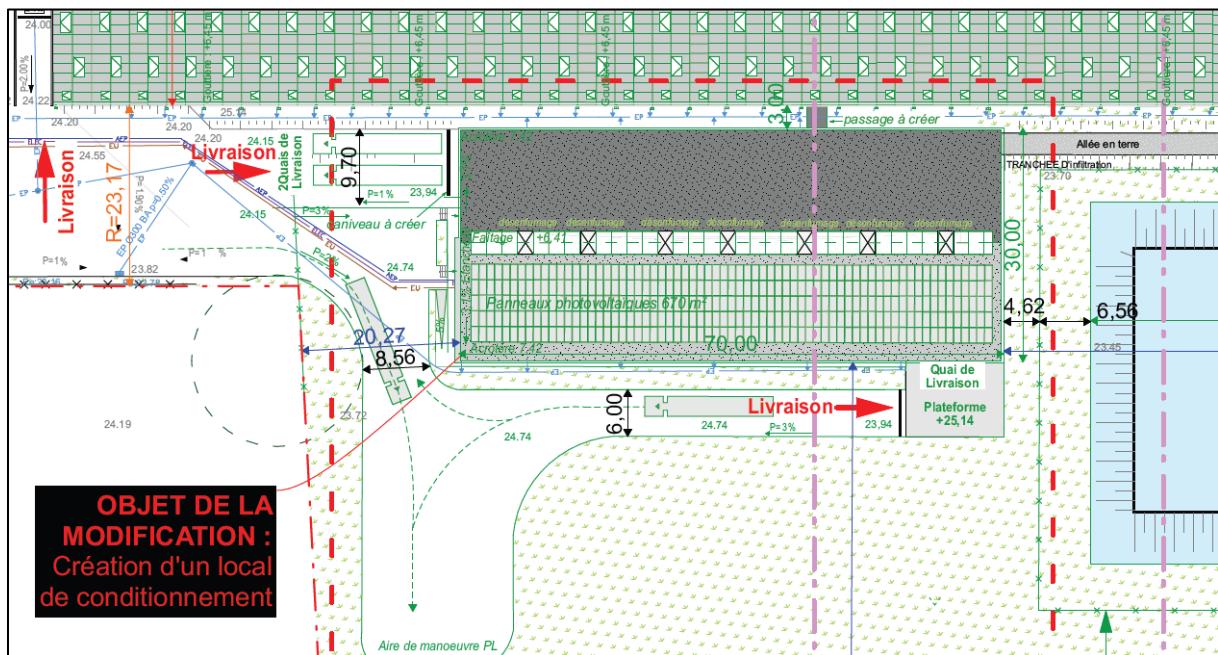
Plan du projet PC 014 167 24 P0006 M01 (source : plan de masse)
